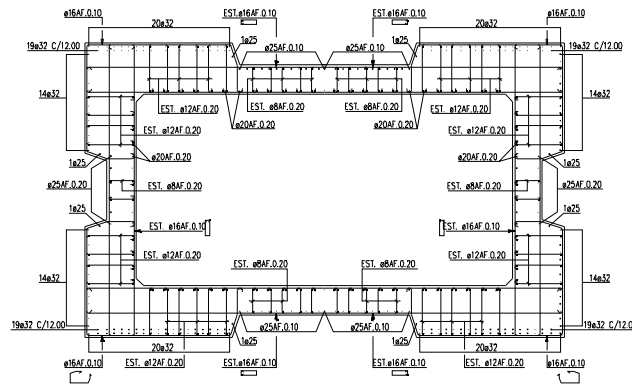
Armadura longitudinal e transversal dos pilares P1 a P5.
